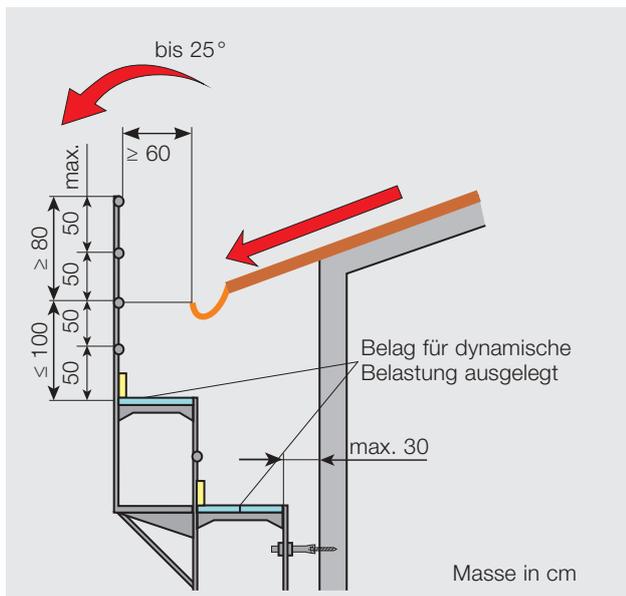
Seitenschutz eines Spenglergangs bei einer Dachneigung bis 25°
